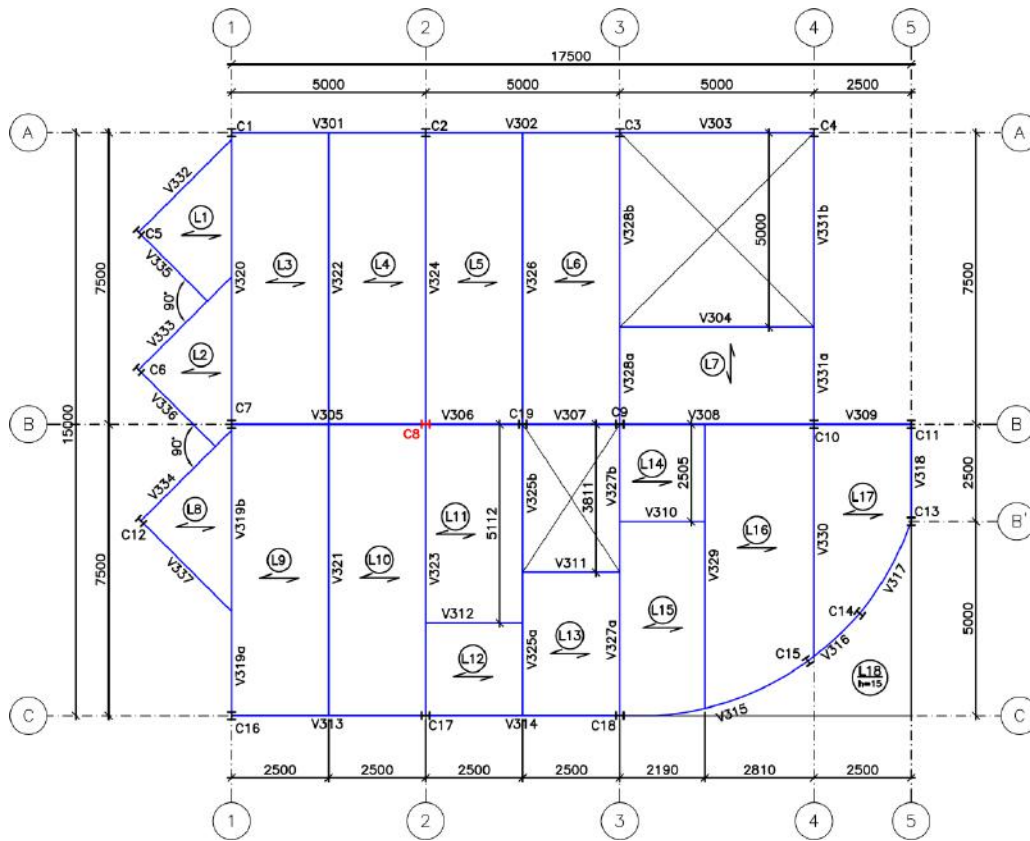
Plano das vigas – EL:+9450mm (cobertura) – Dimensões em mm
